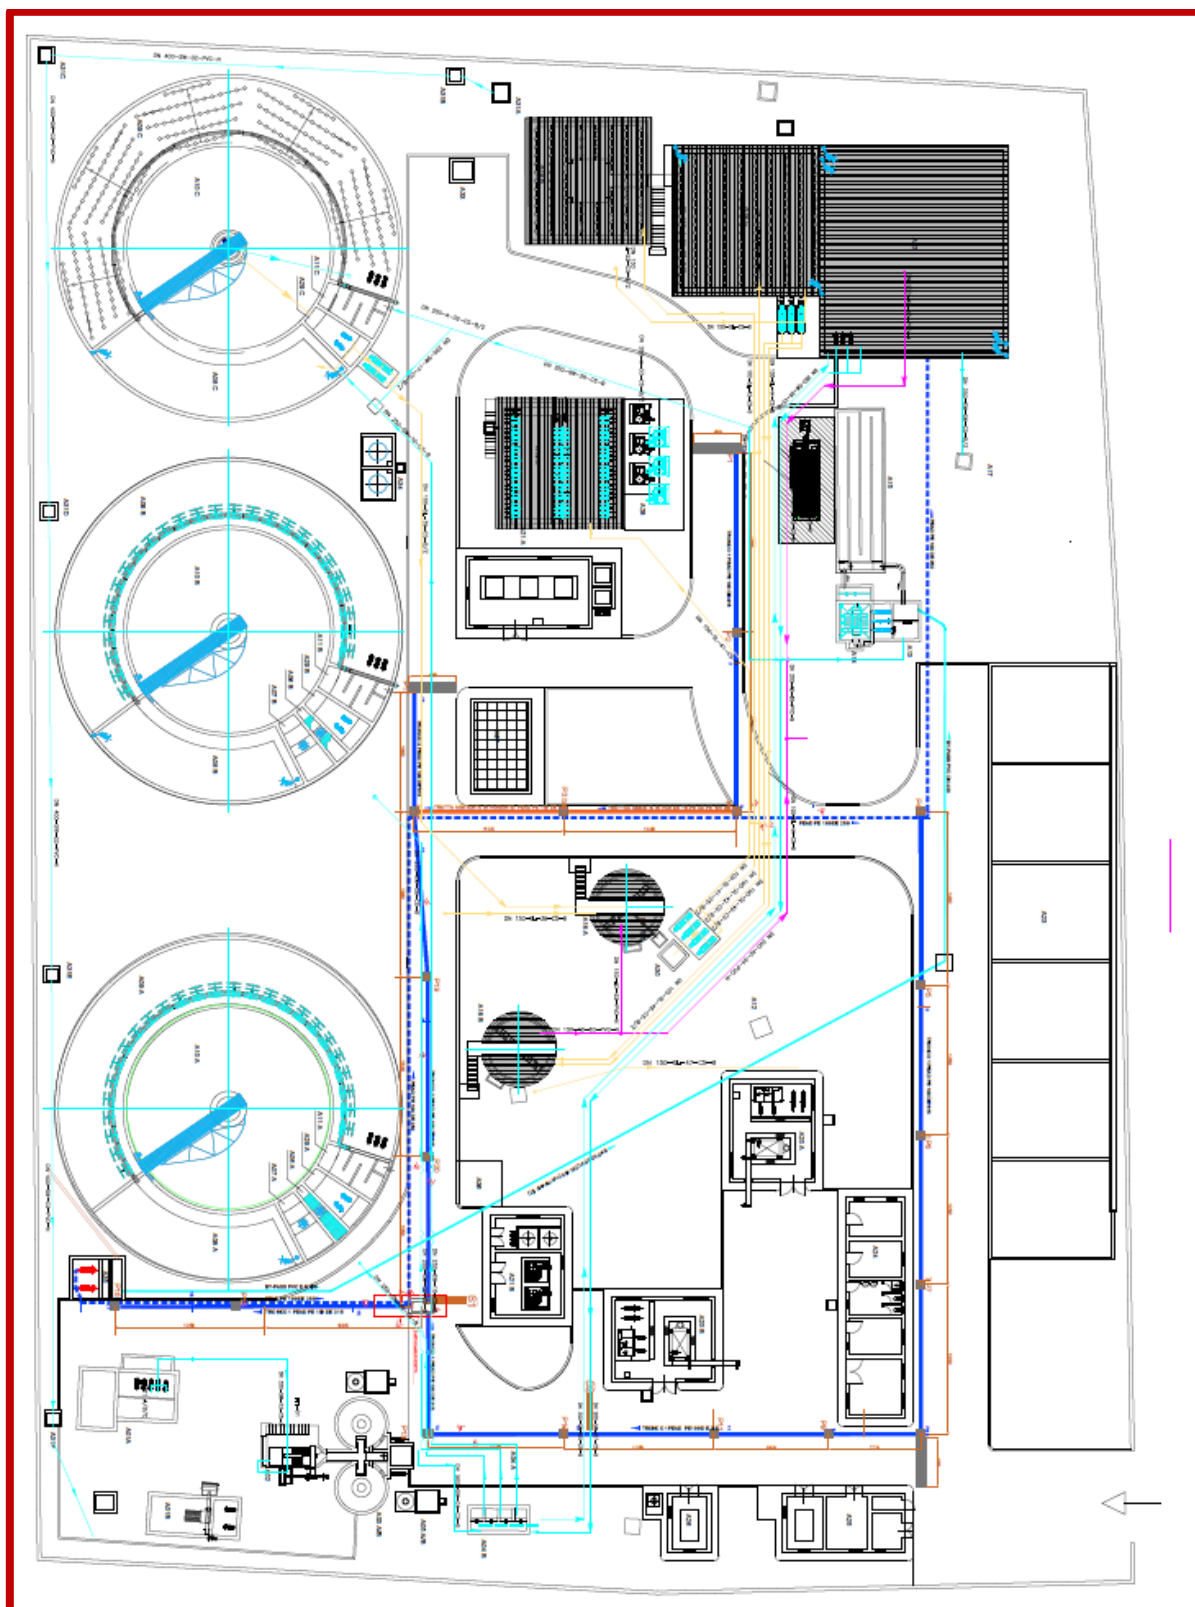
Planimetria esistente impianto di depurazione di Squinzano
